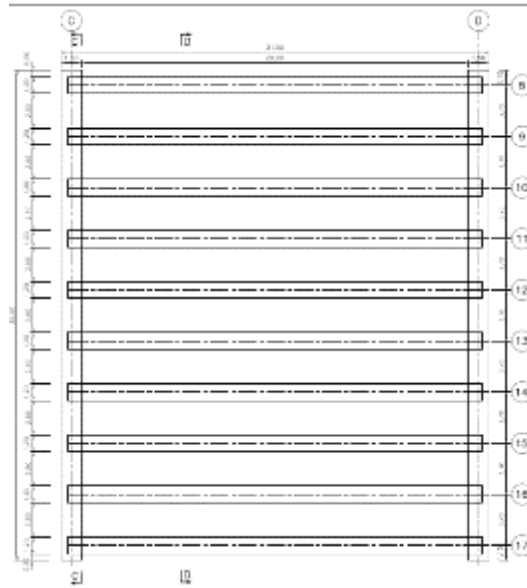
Vista en planta del pedestal de viga hecho de viga cajón pequeña (unidad: metros)
